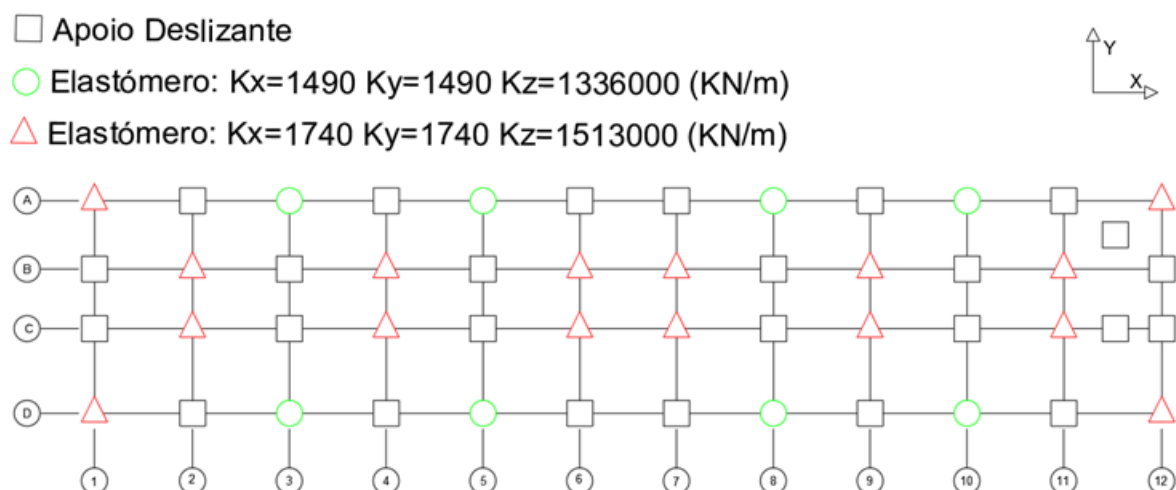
Esquema de Posicionamento dos Dispositivos de Apoio - Solução Final
